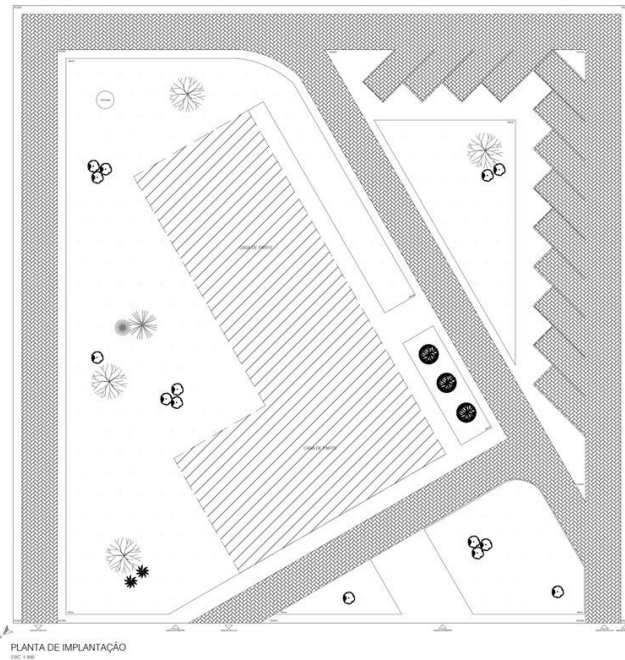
Planta de Implantação. Fonte: Elaborado pela autora.
